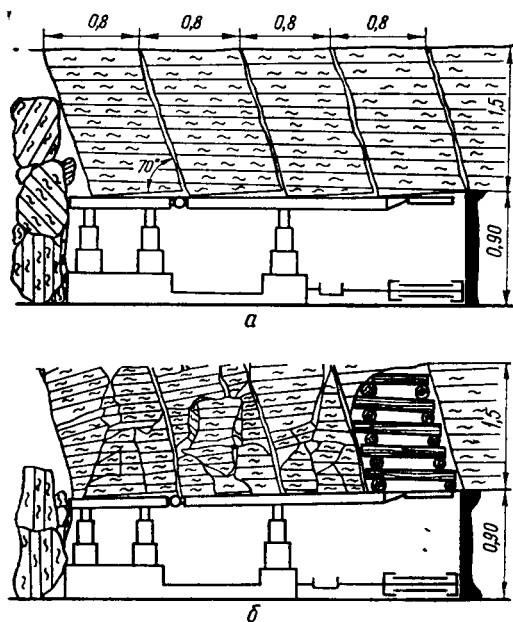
Разрушение рыхлых пород кровли на блоки (а) и мелкие элементы (глыбы) (б).
